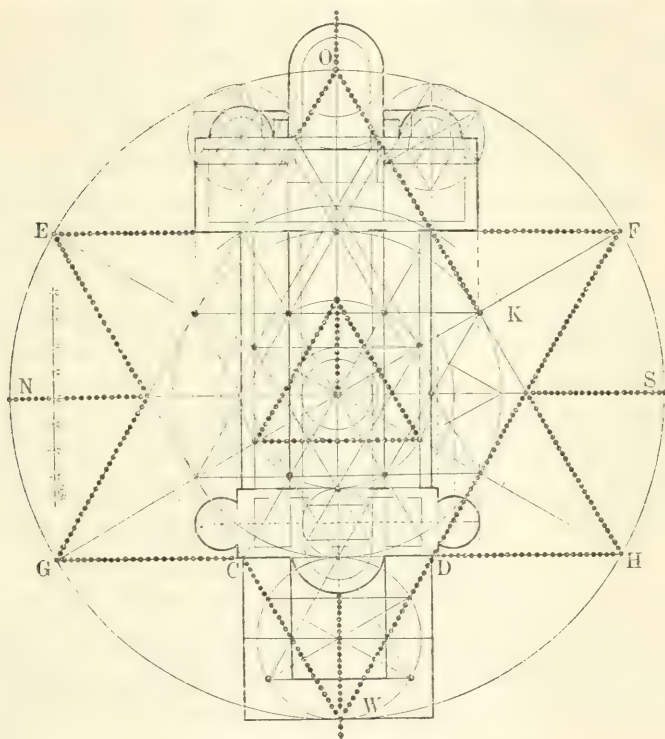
Maria-Baach. Schema des Grundrisses.
